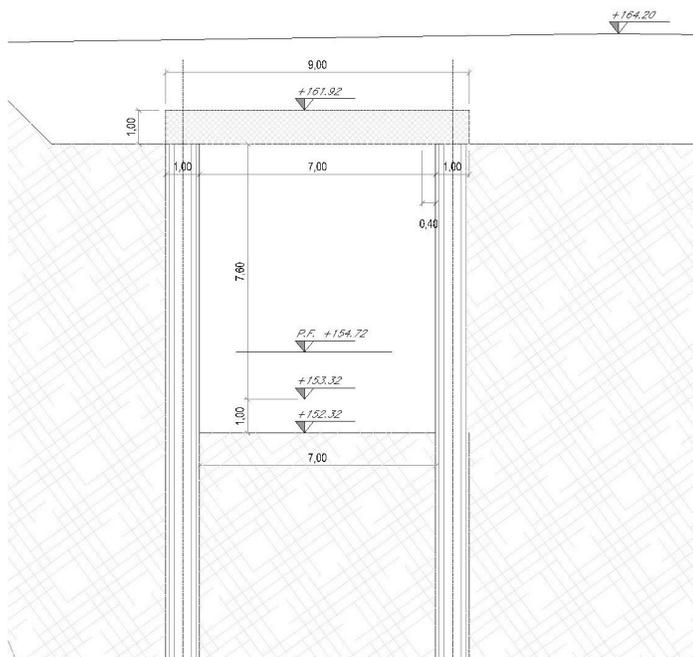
Sezione del manufatto oggetto della presente relazione di calcolo.
